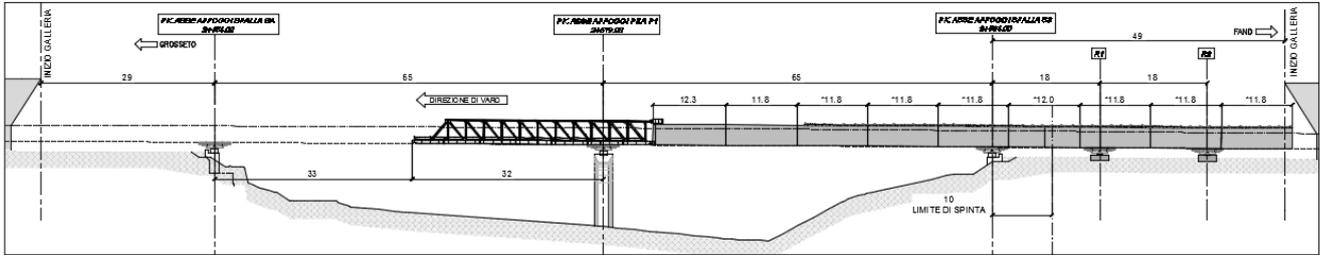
b Viadotto Santa Caterina - Modalità di varo
